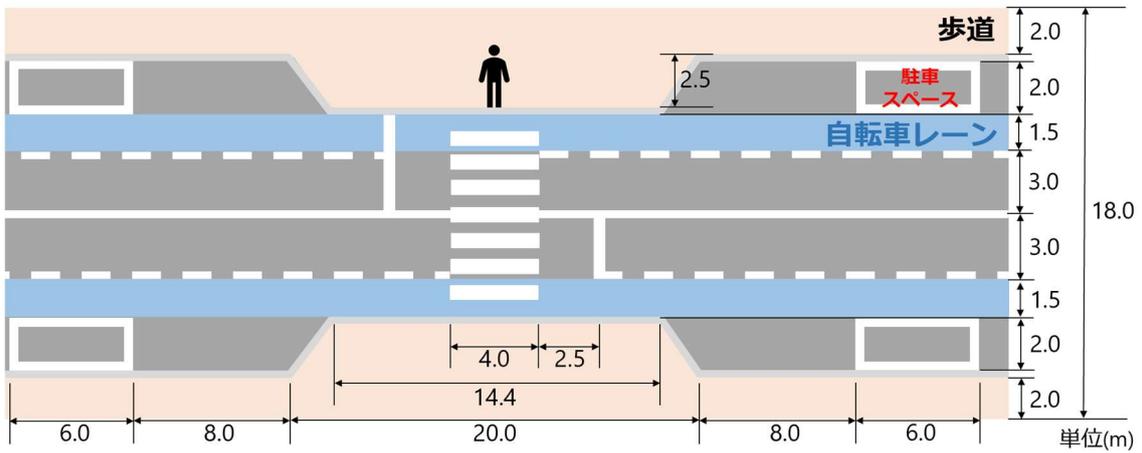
バルブアウト型横断歩道(パターン 6)の平面図
